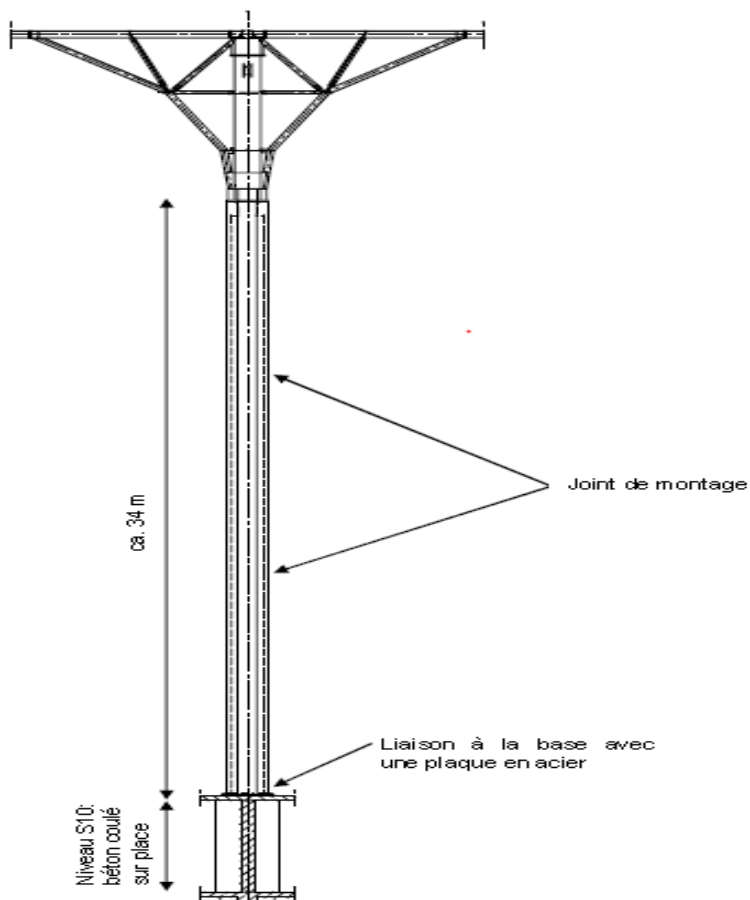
structure complète d'un de ces poteaux
